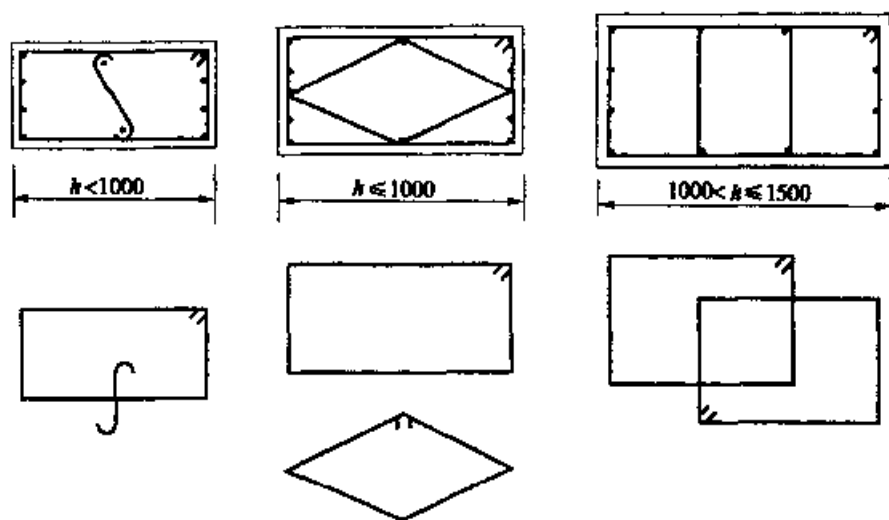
偏心受压柱的纵向构造钢筋及复合箍筋(尺寸单位: mm)
